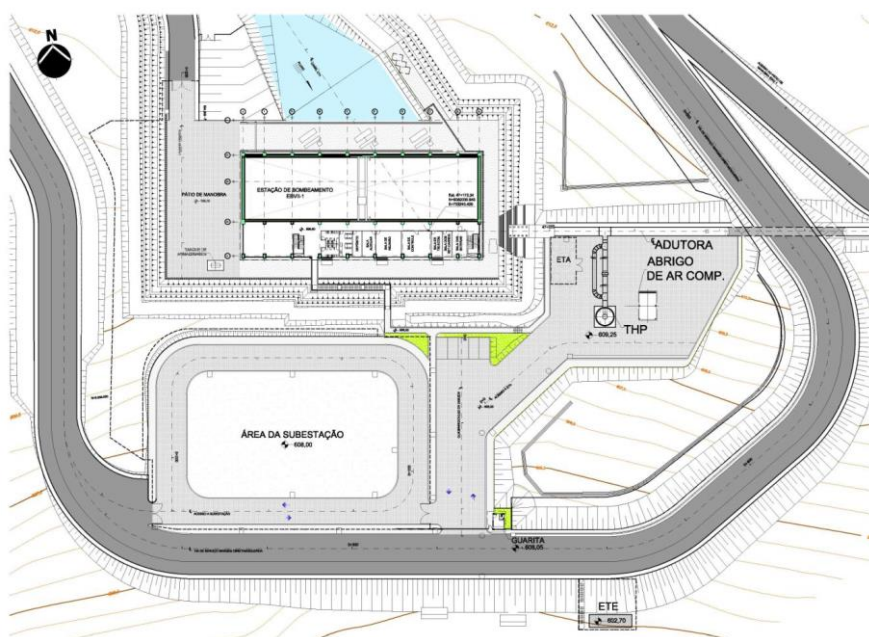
Arranjo da Estação de Bombeamento - EBVII-1
